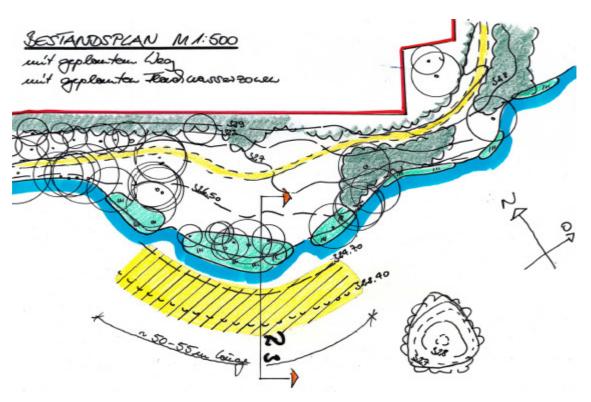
Detailplan mit Lage der geplanten Flachwasserzone im Hirschauer Baggersee. Die gelbe Schraffur markiert den Seebereich, in dem die Aufschüttung erfolgen soll.
